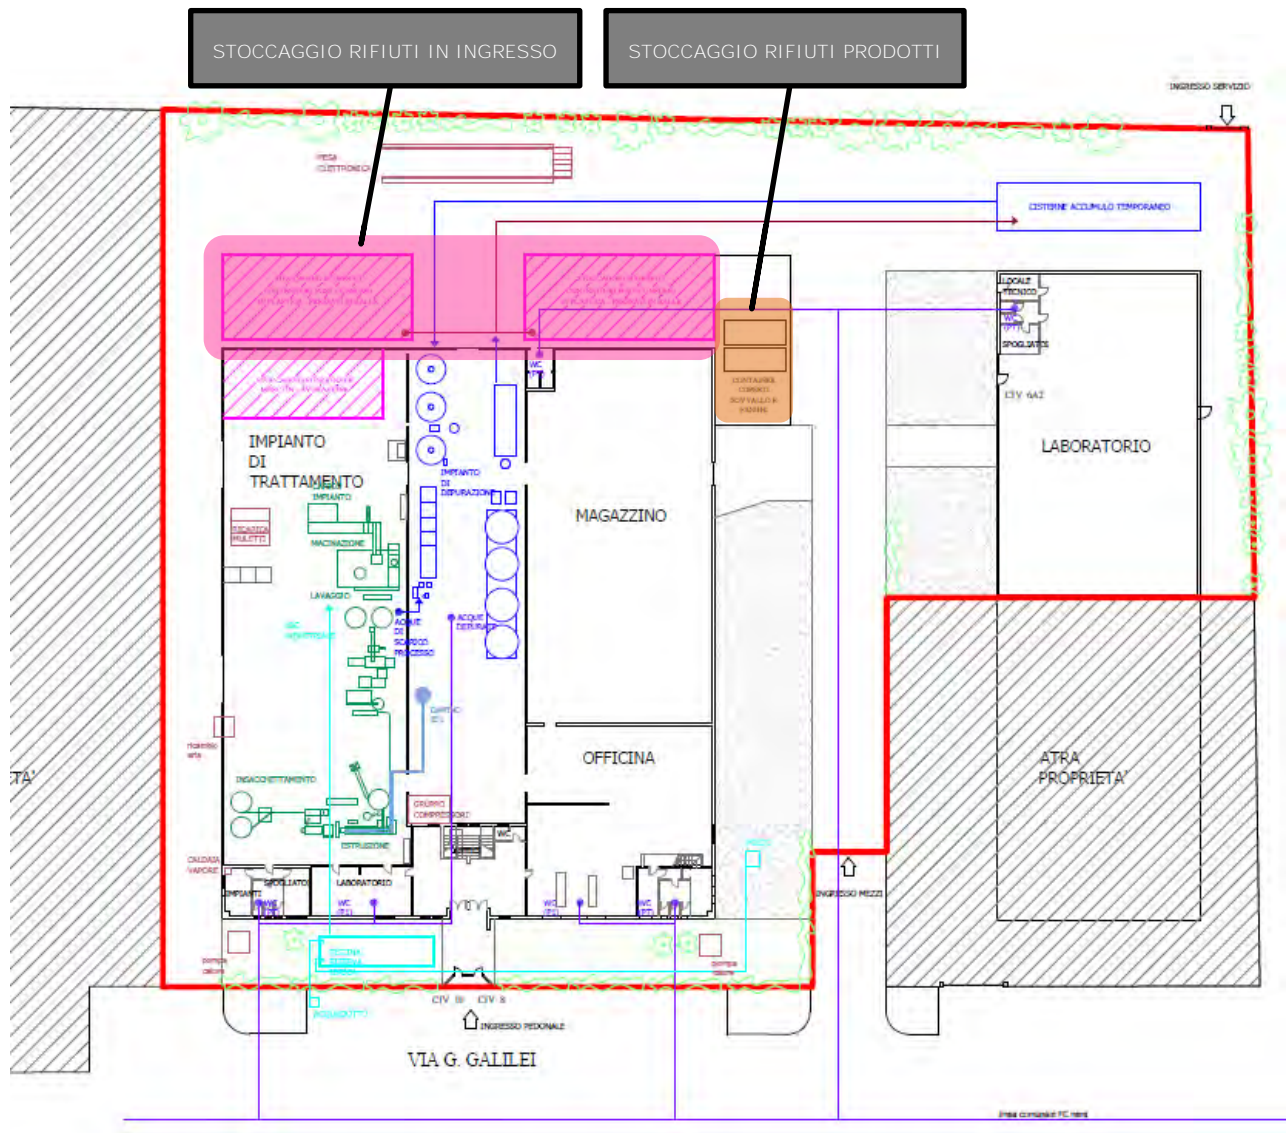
Estratto da planimetria 10b con individuazione aree stoccaggio rifiuti in ingresso e prodotti
